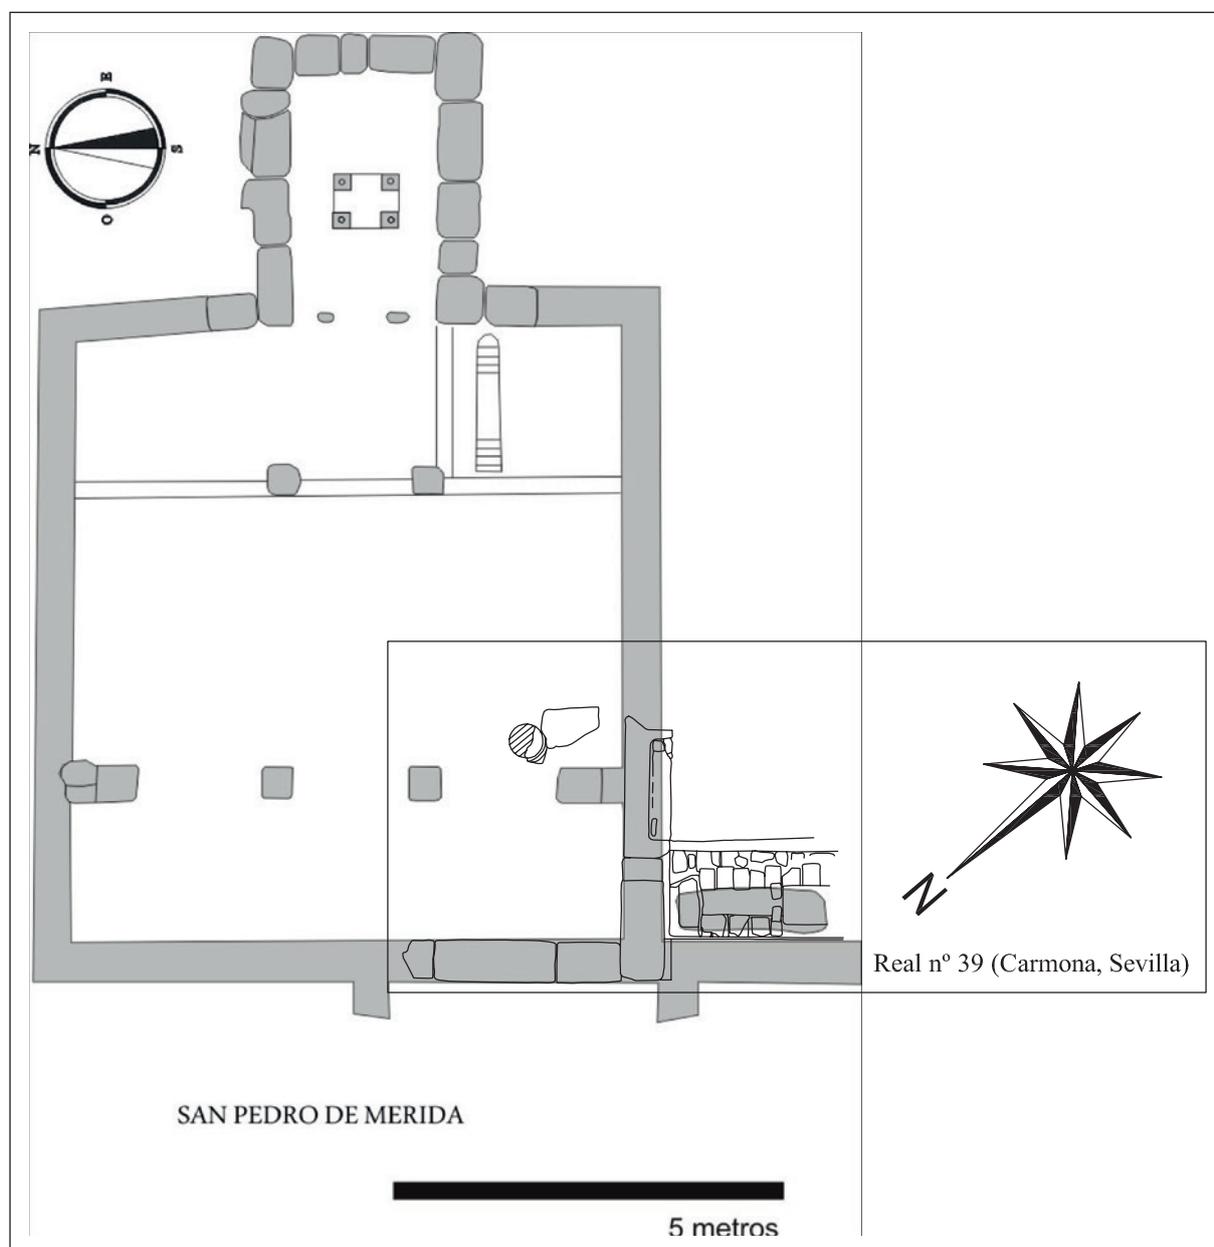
Superposición de la segunda fase constructiva sobre la planta de la iglesia de San Pedro de Mérida (San Pedro de Mérida Badajoz).
